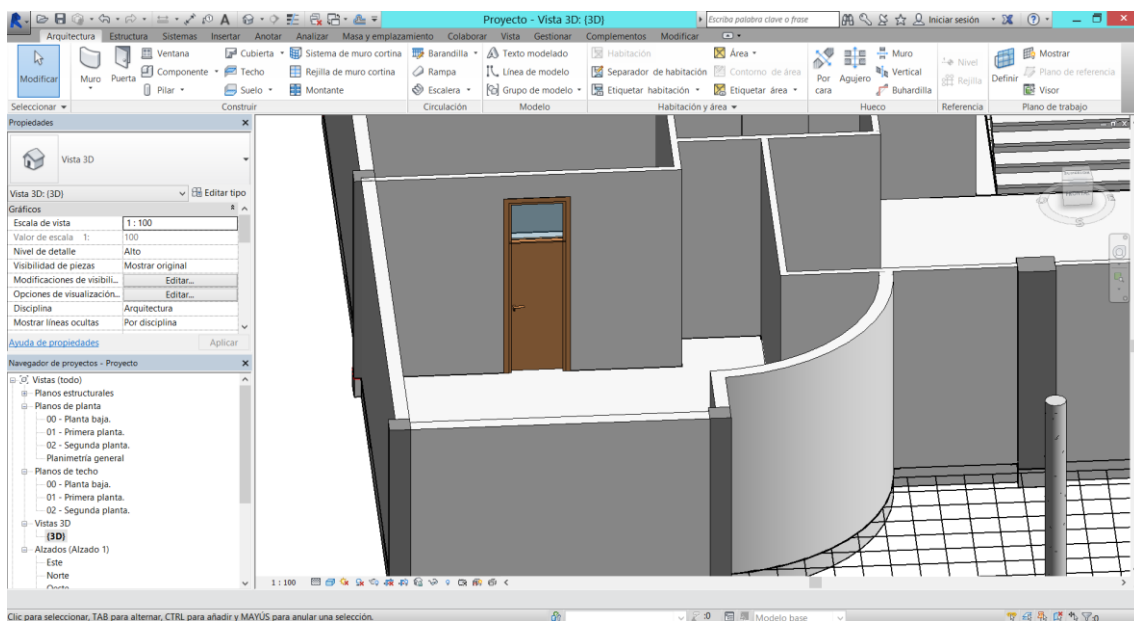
Vista 3D de la puerta interior: Puerta 1 hoja con cristal superior 80 x 210 cm. Fuente: Elaboración propia.
